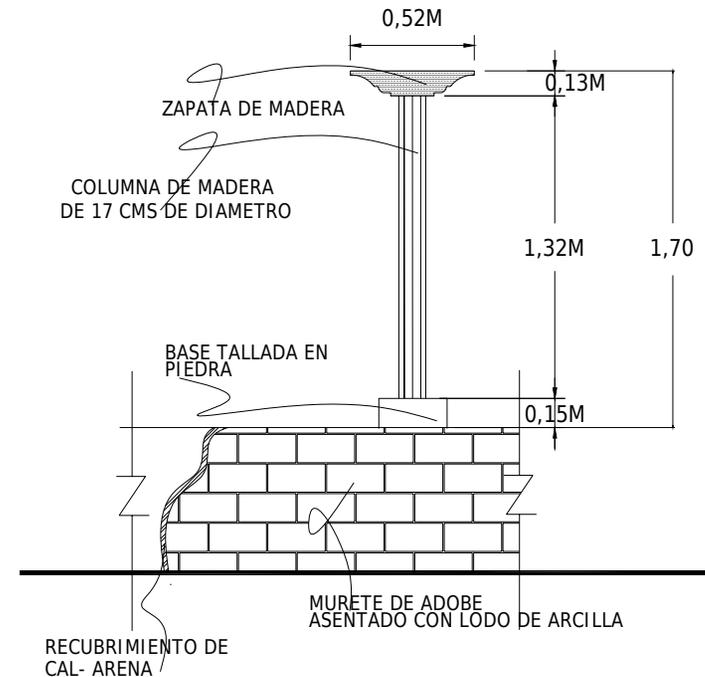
DETALLE DE APOYOS AISLADOS DE LA VIVIENDA TIPO.
